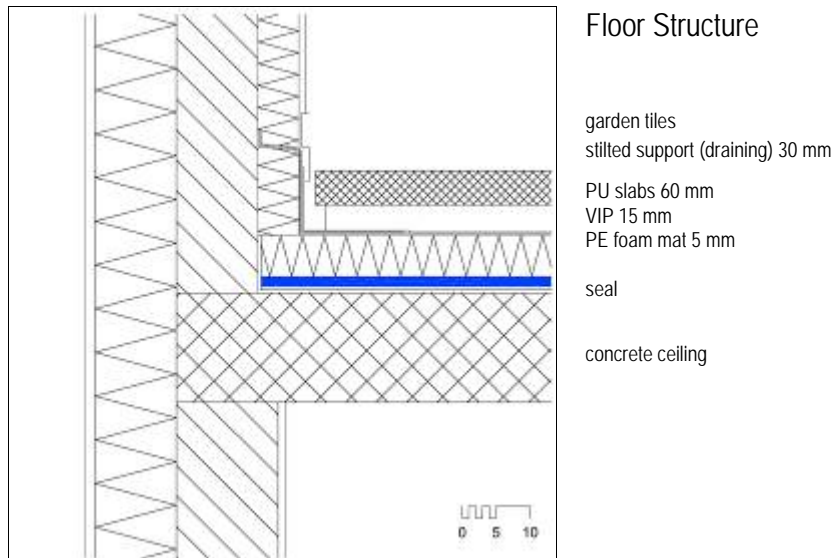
Vertikalschnitt durch das Anschlussdetail an der Brüstung.
